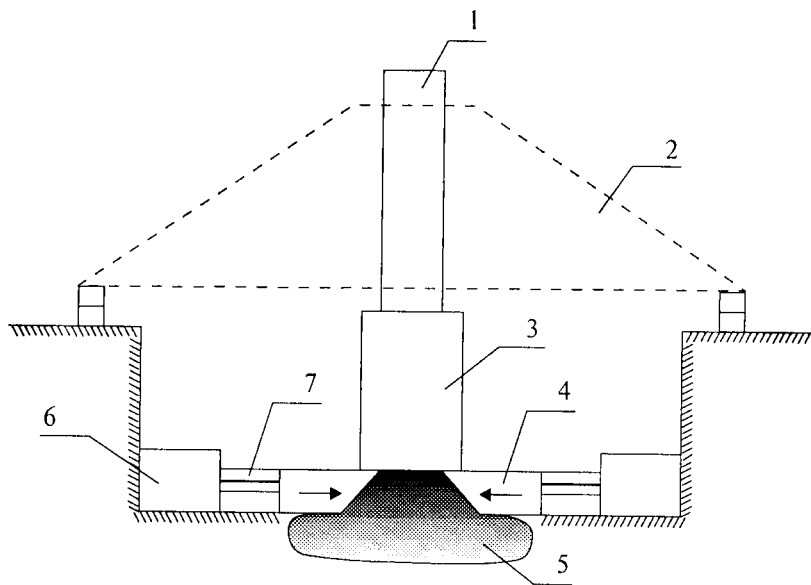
Усиление фундамента с обжатием основания элементами уширения
